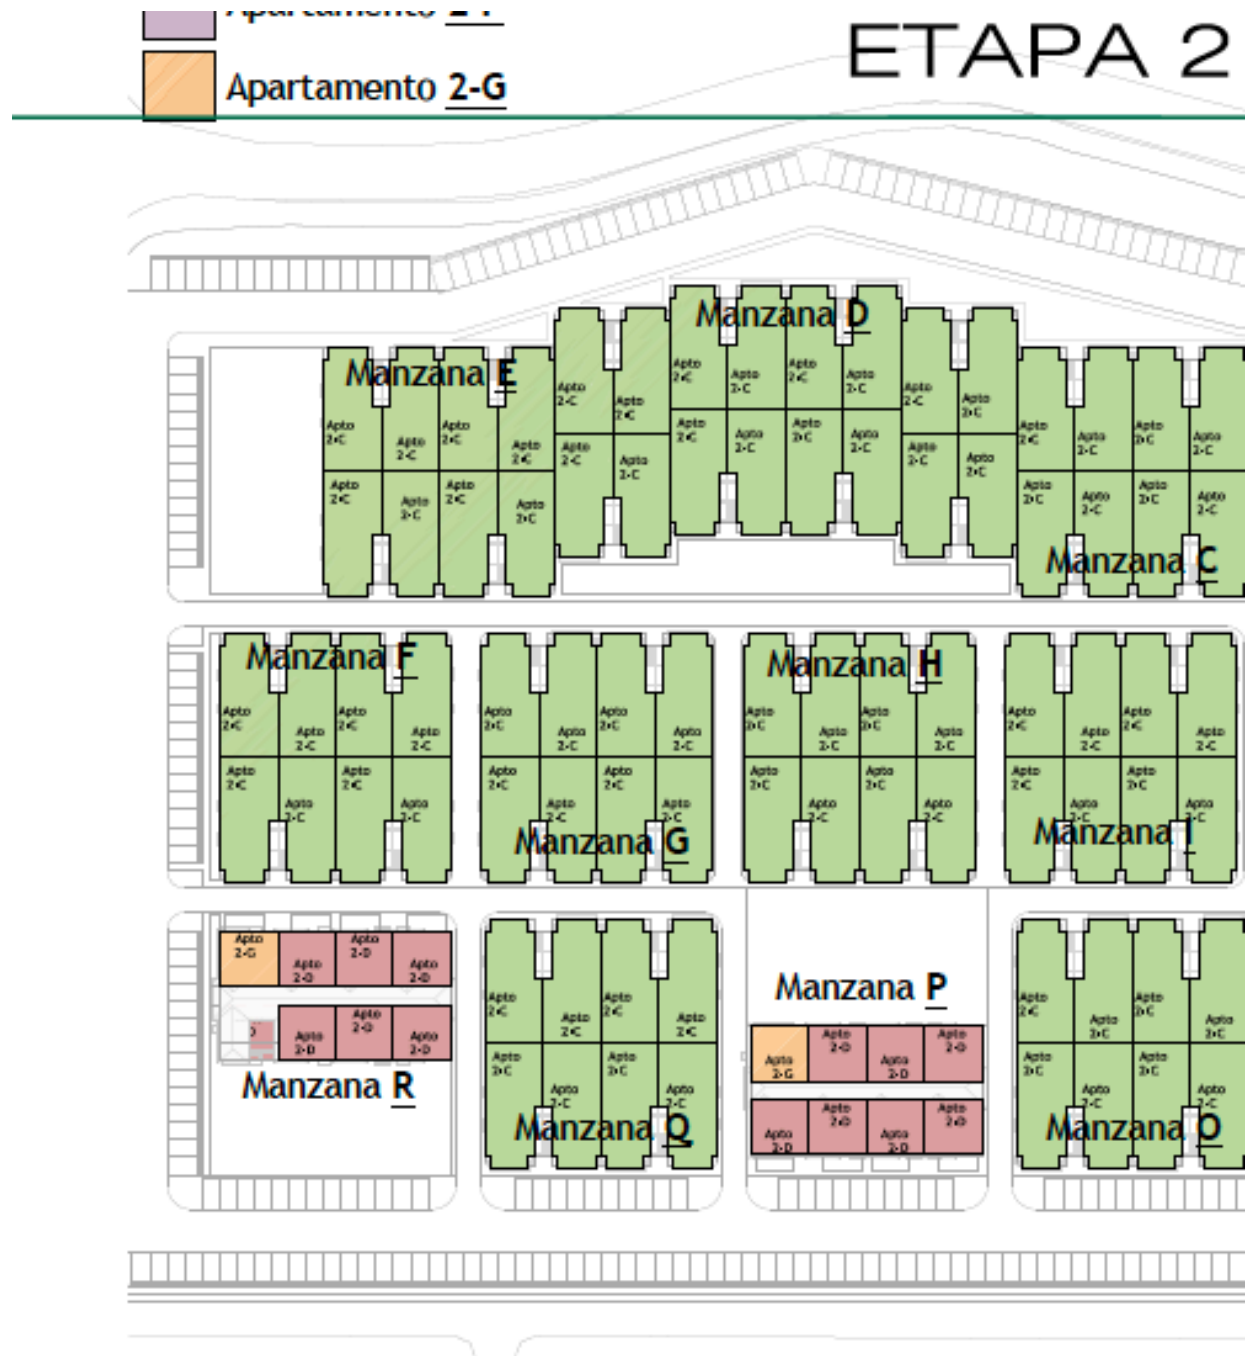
Vista en planta de los apartamentos de la etapa 2
